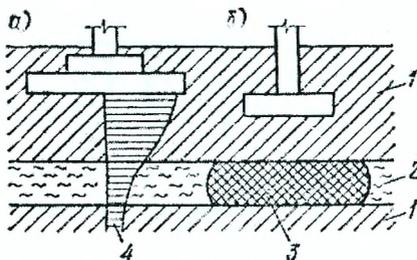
Варианты устройства фундаментов при напластовании грунтов по схеме II
